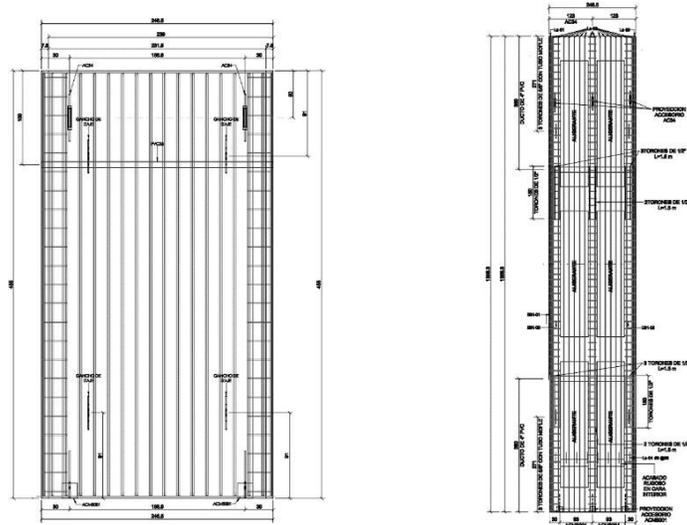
A la izquierda muro prefabricado macizo (MPM) y a la derecha muro prefabricado aligerado (MPA).
